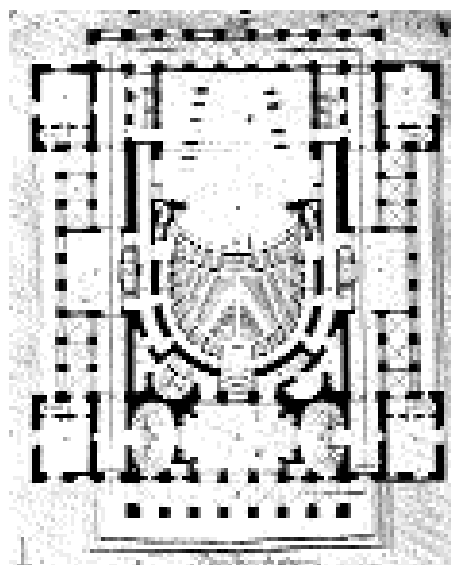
« Plan du rez-de-chaussée », projet d'une salle de comédie isolée. Dessin de B. POYET, Grand Prix 1768.
